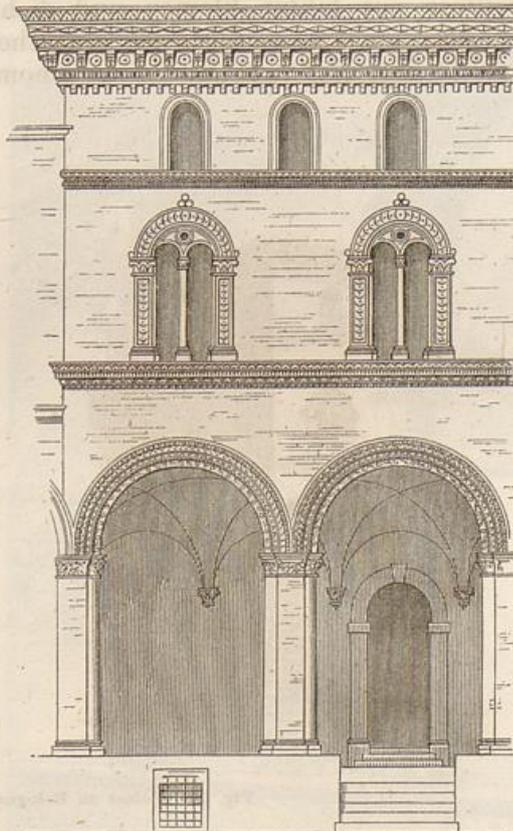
Pal. Fava in Bologna, Façade. (Nohl.)
